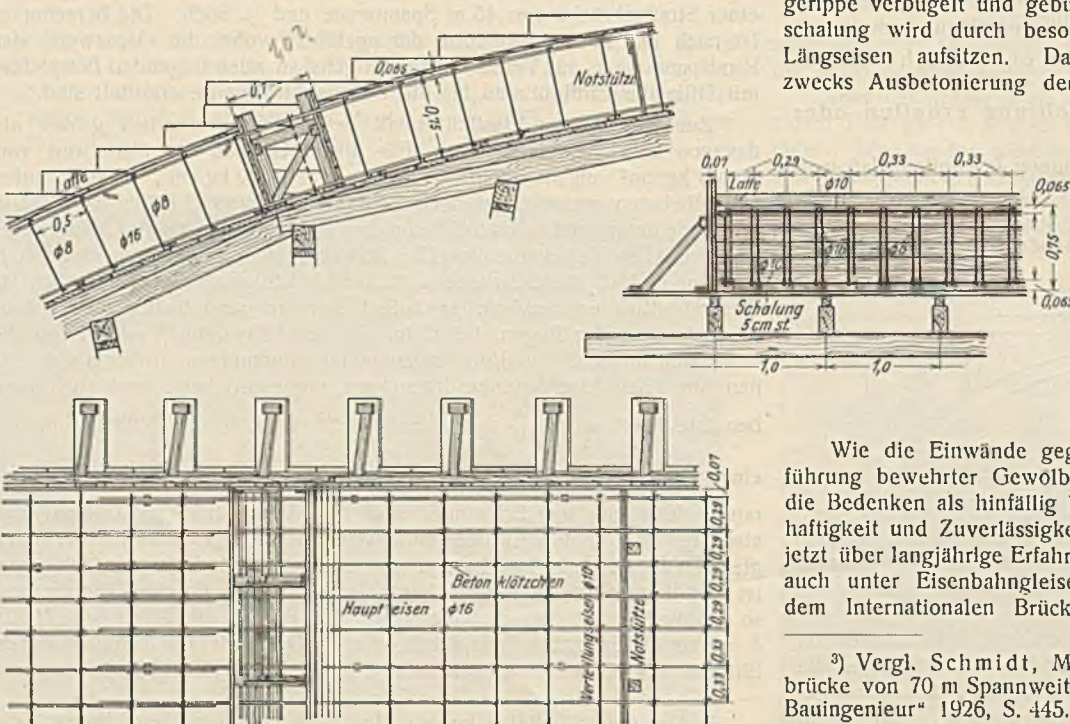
Anordnung der Bewehrung für Gewölbe bei Betonierung in Lamellen.
